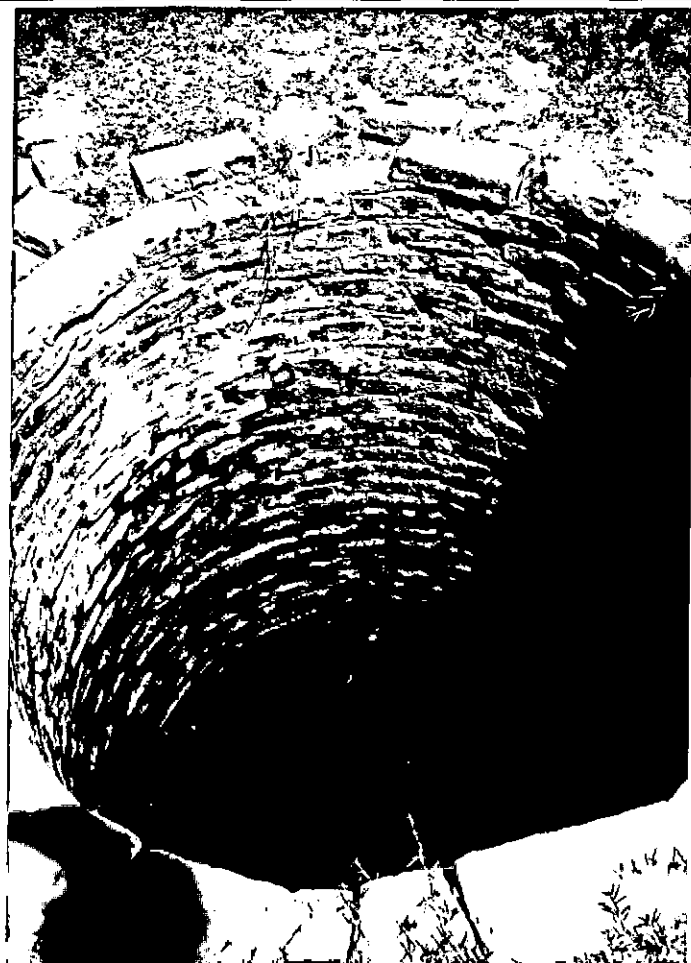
Paraje Lote 17, pozo cavado de gran diámetro, calzado con ladrillos, utilizado para el abastecimiento de agua del lugar que funciona como comedor (Foto N° 26).
